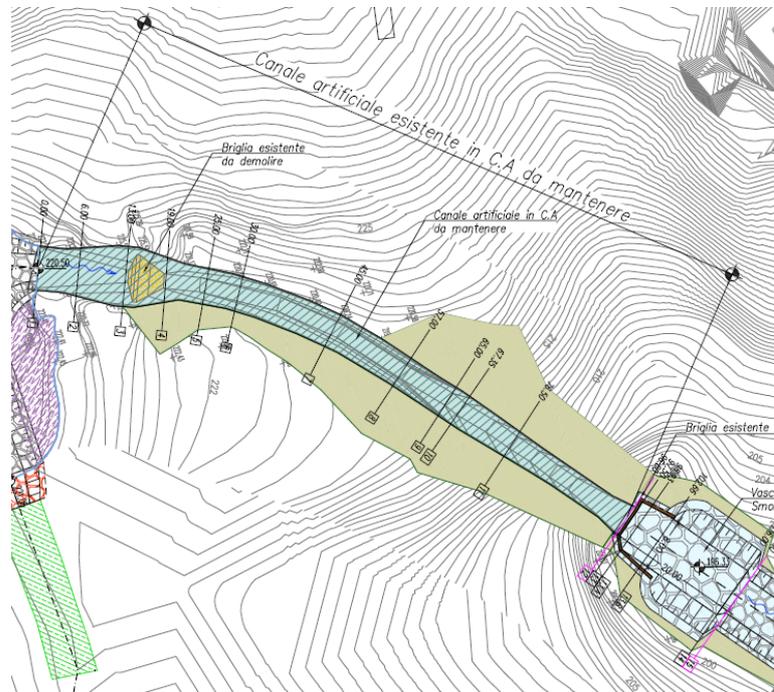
Planimetria Canale esistente – Borro Percussente
